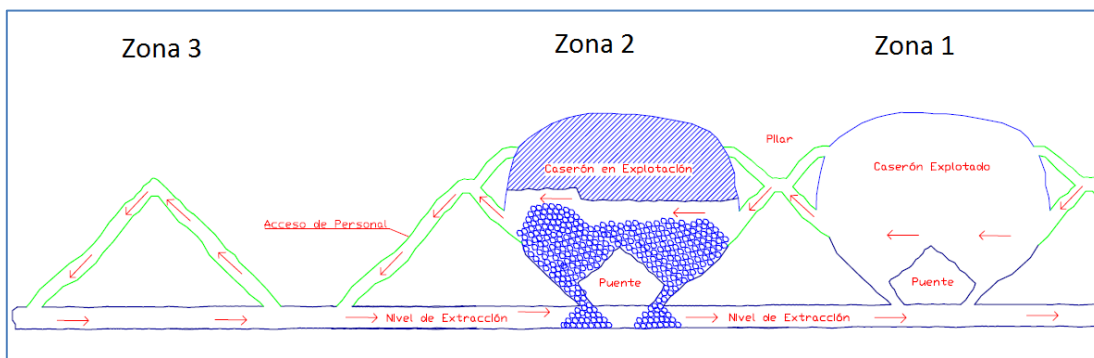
Secuencia construcción desarrollos para Shrinkage Stopping-Parte 4
